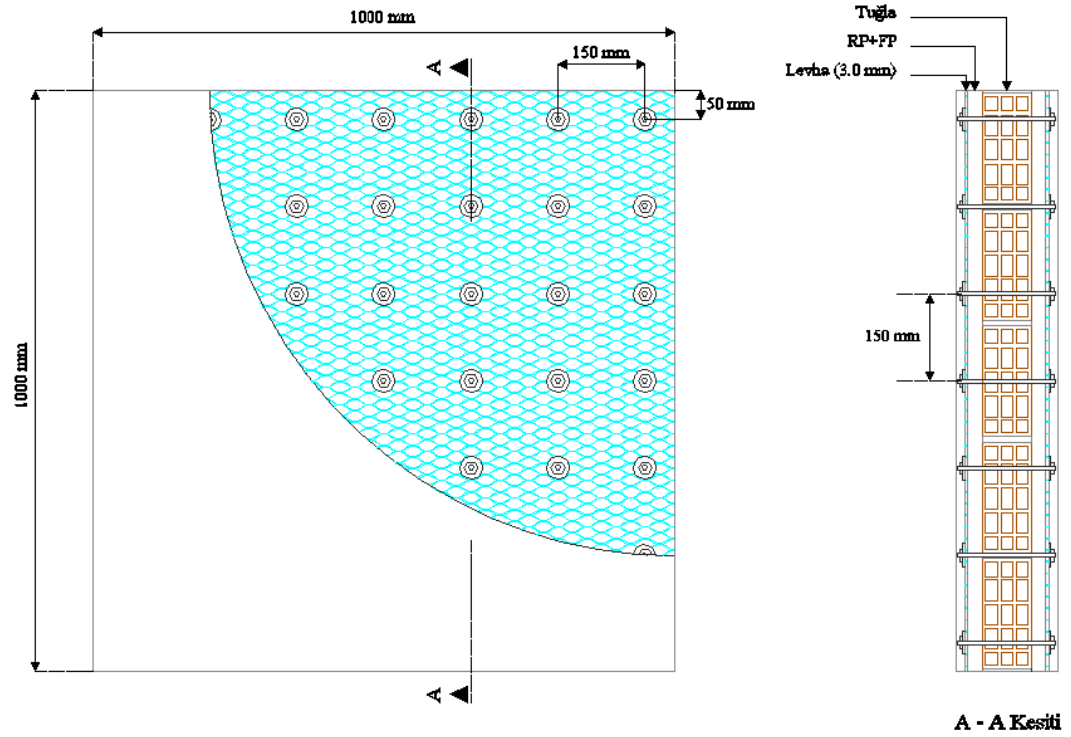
FP2,0-150 deney elemanın boyutları ve güçlendirme detayları
